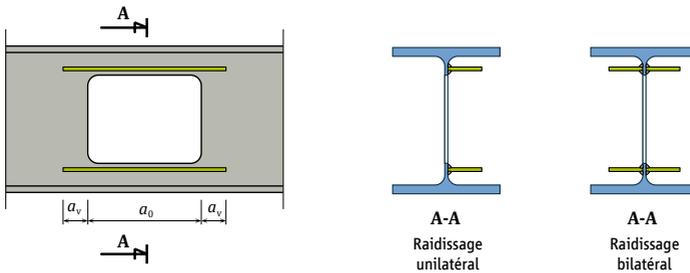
Raidissage longitudinal d'une ouverture d'âme isolée
